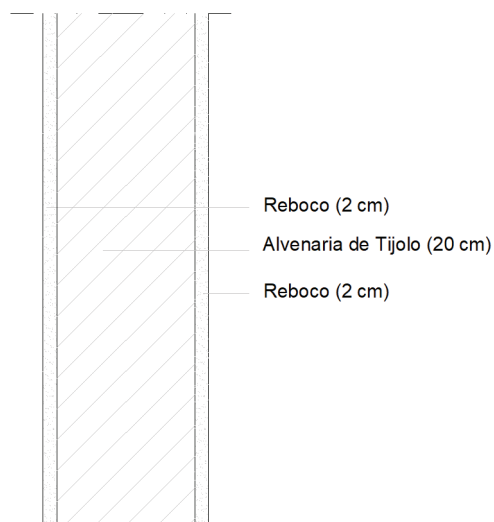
Pormenor construtivo da parede interior tipo XII (circulação)
